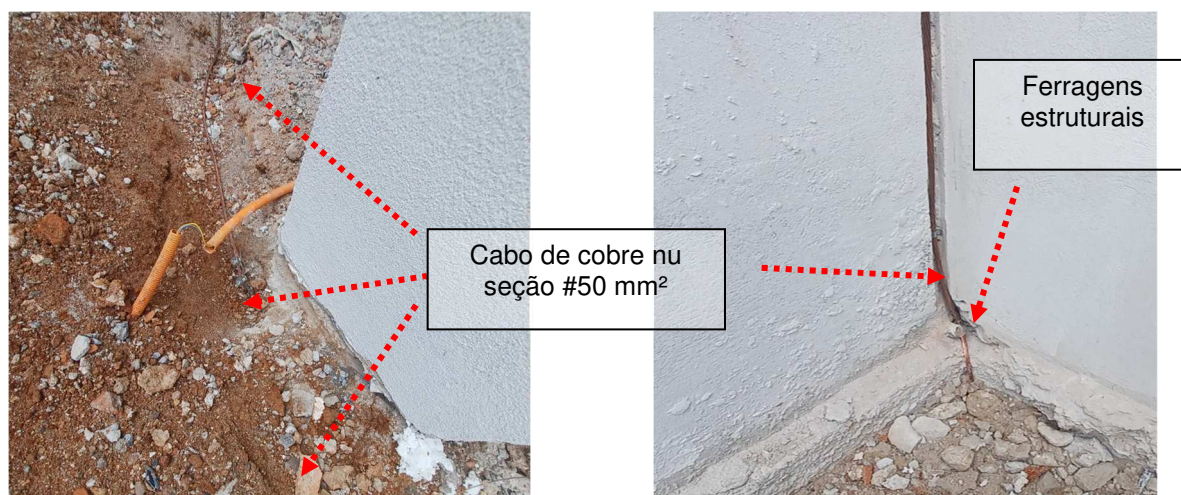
e 93: Trecho de malha enterrada em cabo de cobre nu #50mm² construída entre as ferragens estruturais da edificação e a descida do SPDA.
